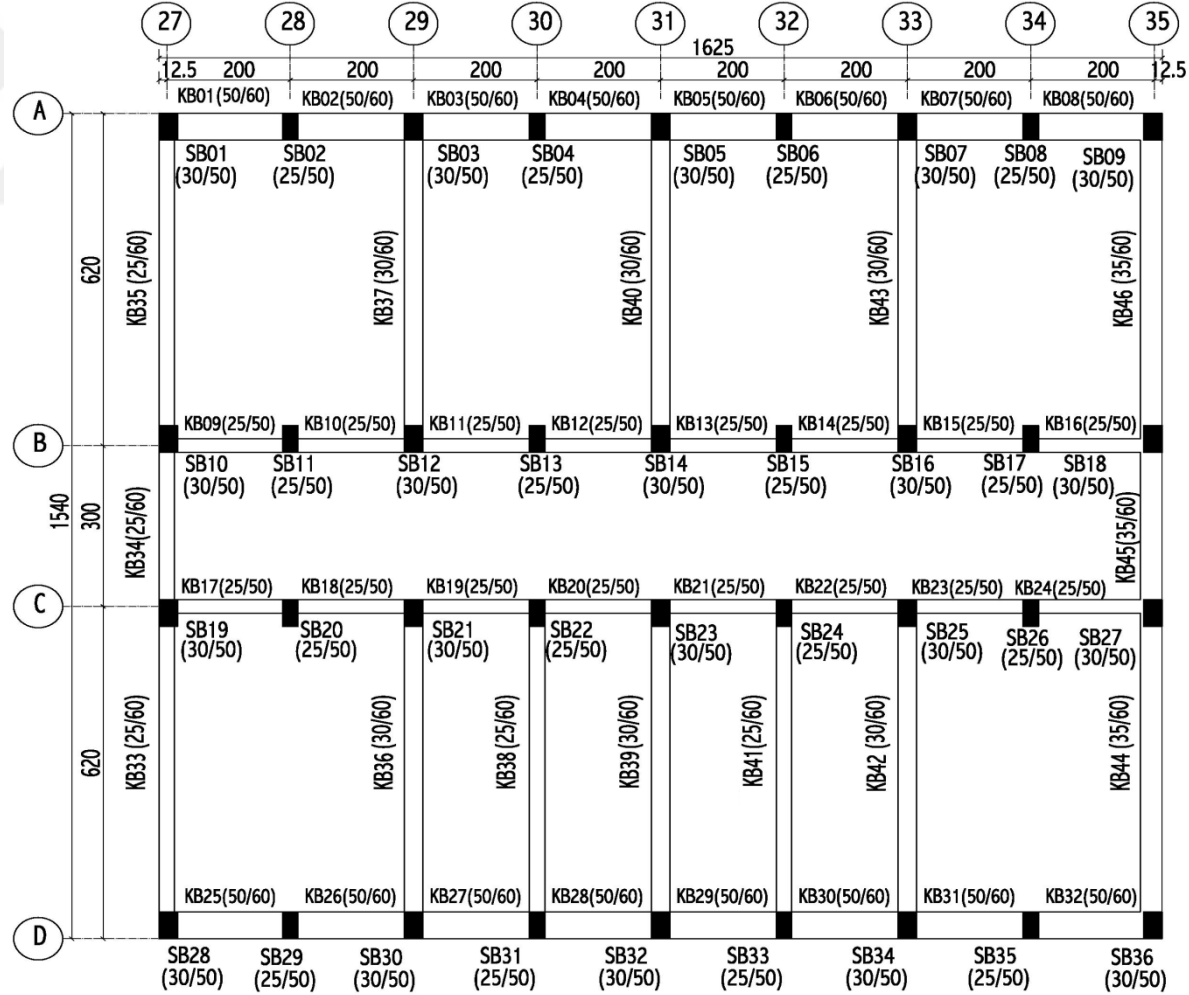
Ülkü Ortaokulu-A Blok kalıp planı
